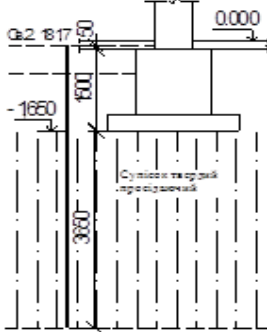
Вертикальна прив'язка фундаменту на перетині осей Г і З.
